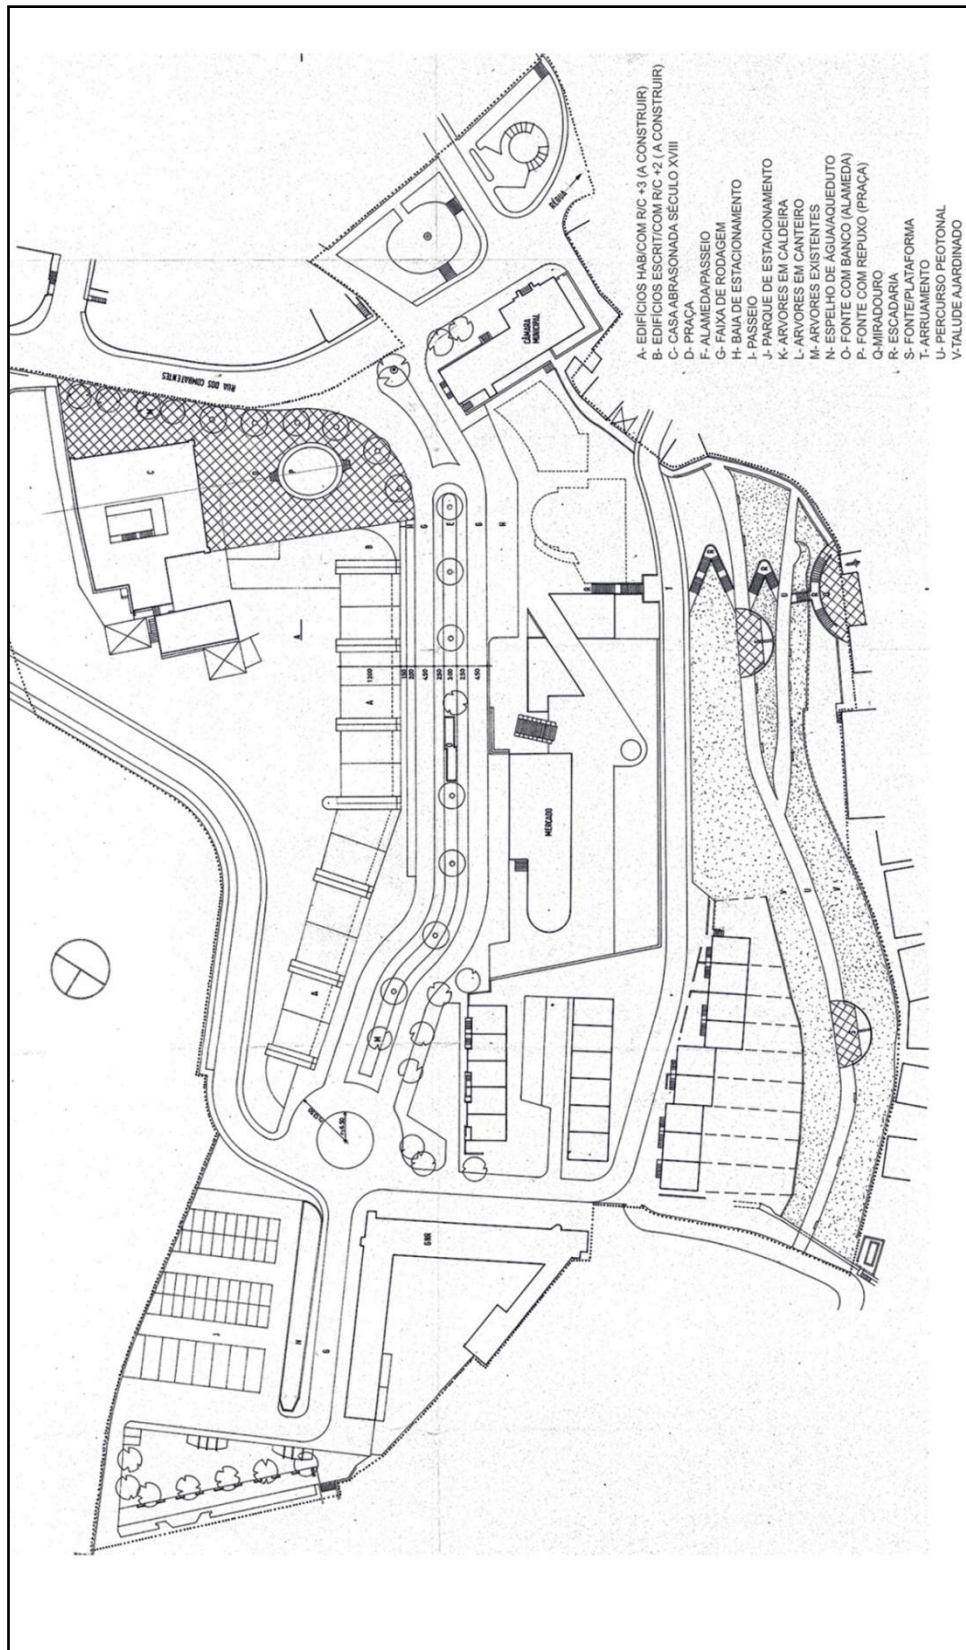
Planta de síntese do Plano de Reabilitação para a Alameda 13 de Janeiro (1996)
